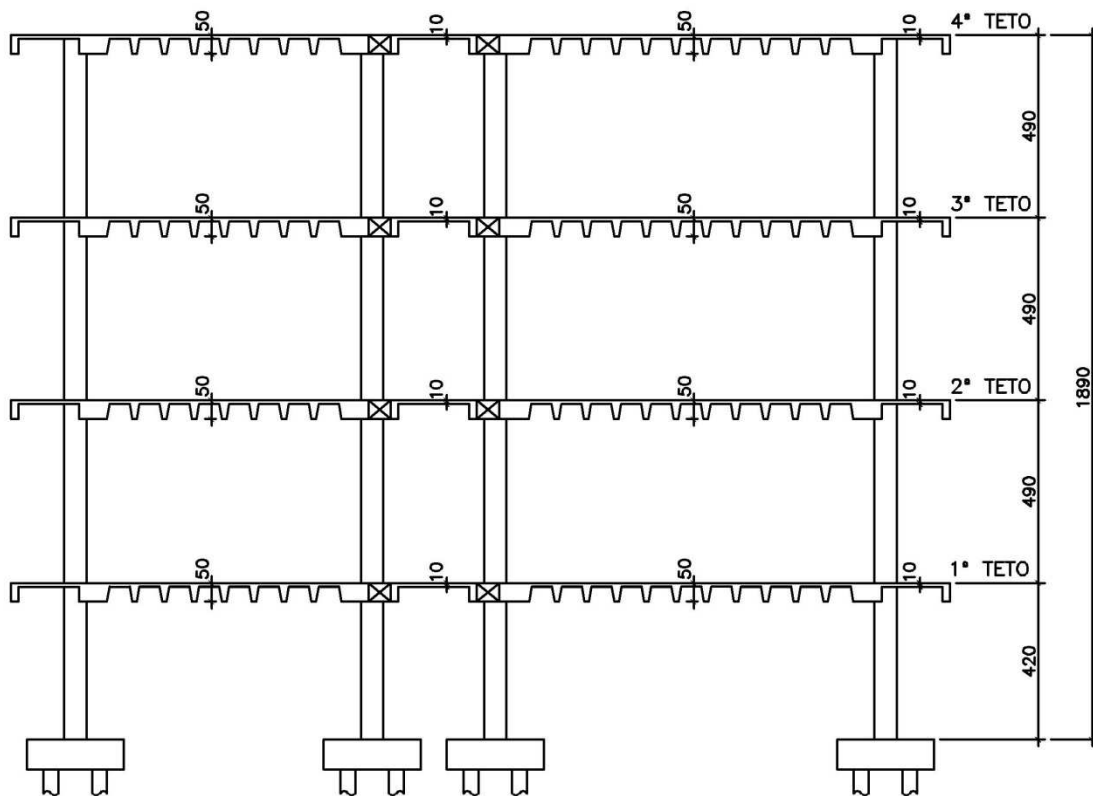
Corte esquemático AA da edificação em estudo.
